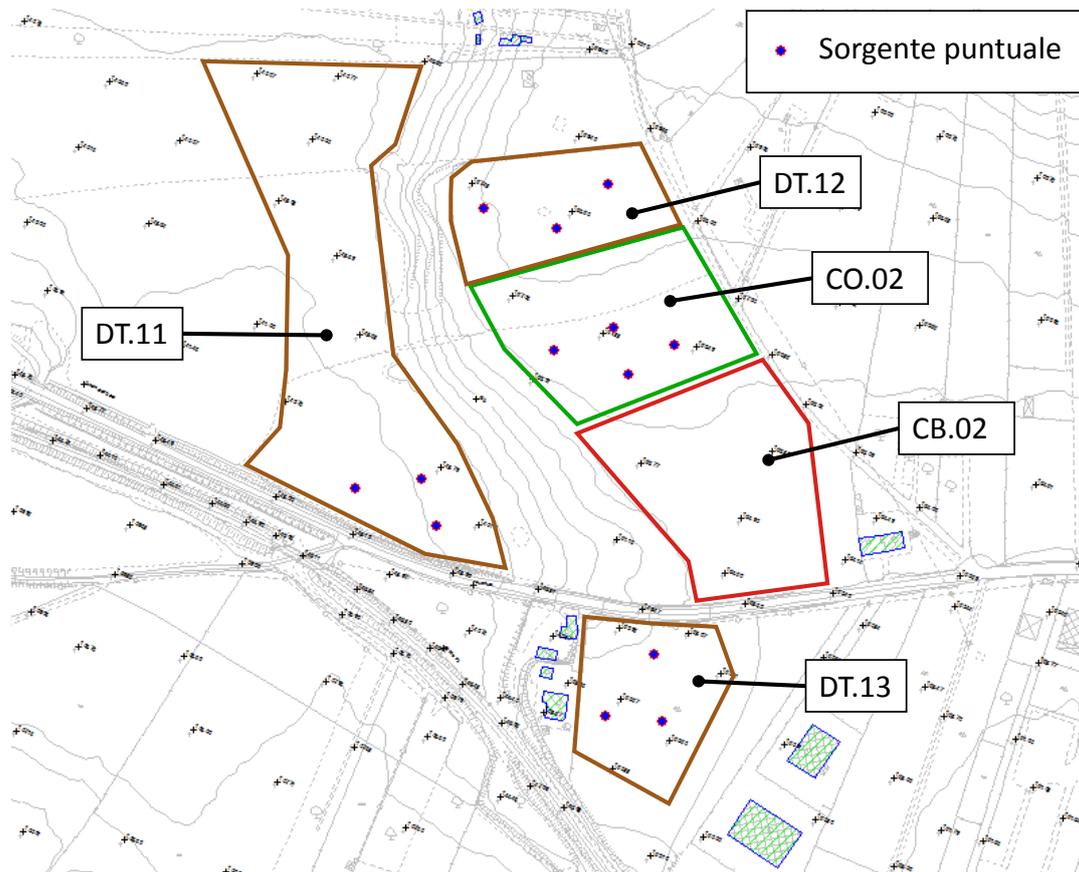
Planimetria in SoundPlan dello scenario oggetto di simulazione
